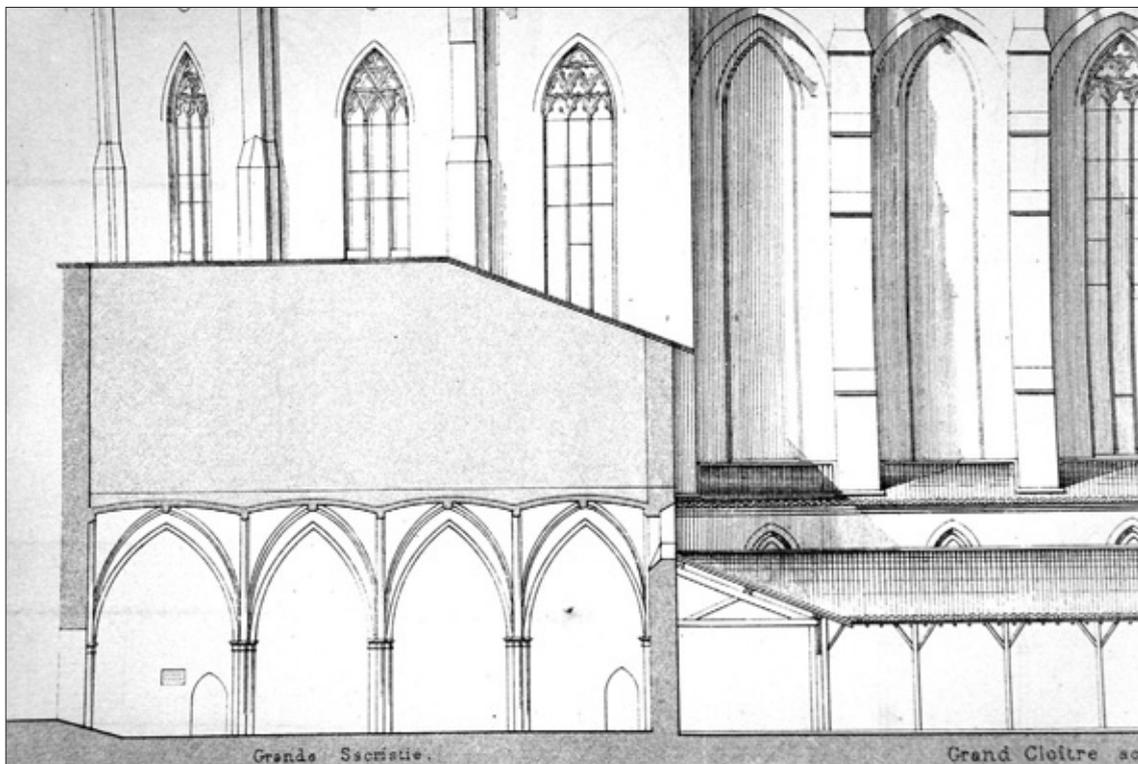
COUPE SUR LA SACRISTIE ET LE CLOÎTRE, 1876, planche 3, détail. *Relevé de J.-J. Esquié.
